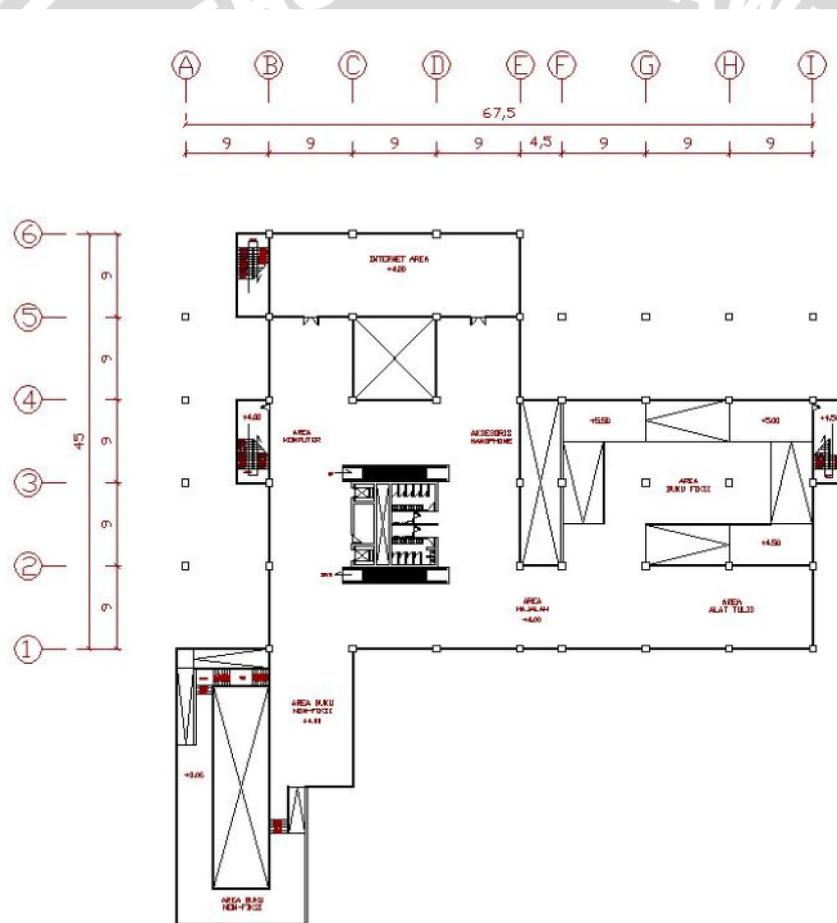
Denah lantai 1 plan Toko Buku Paling Lengkap
